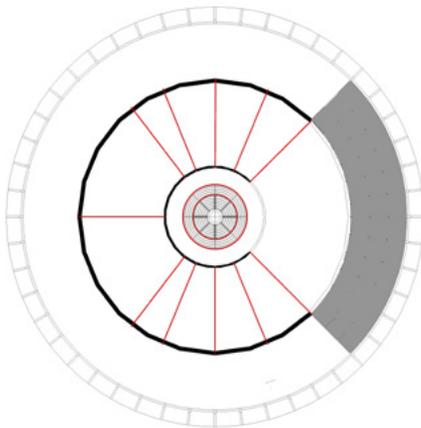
181. Grundriss - Rinterzelt
